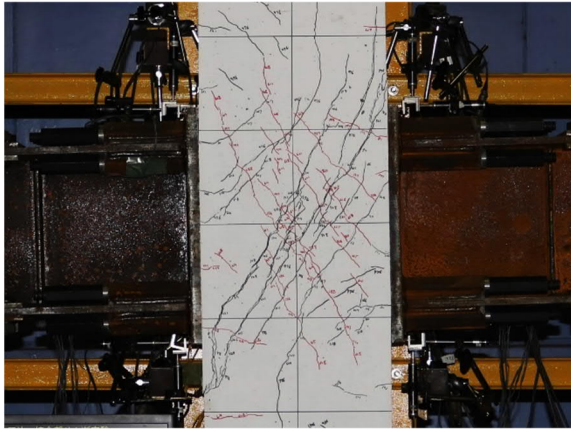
最大耐力時ひび割れ状況 (No2)
